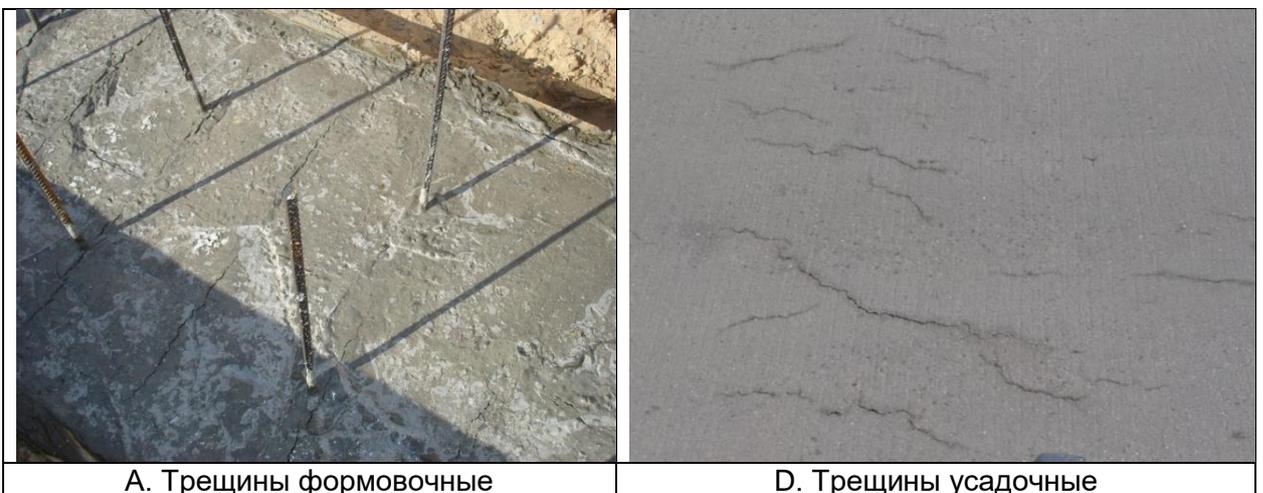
Характерные трещины в железобетонных конструкциях.
